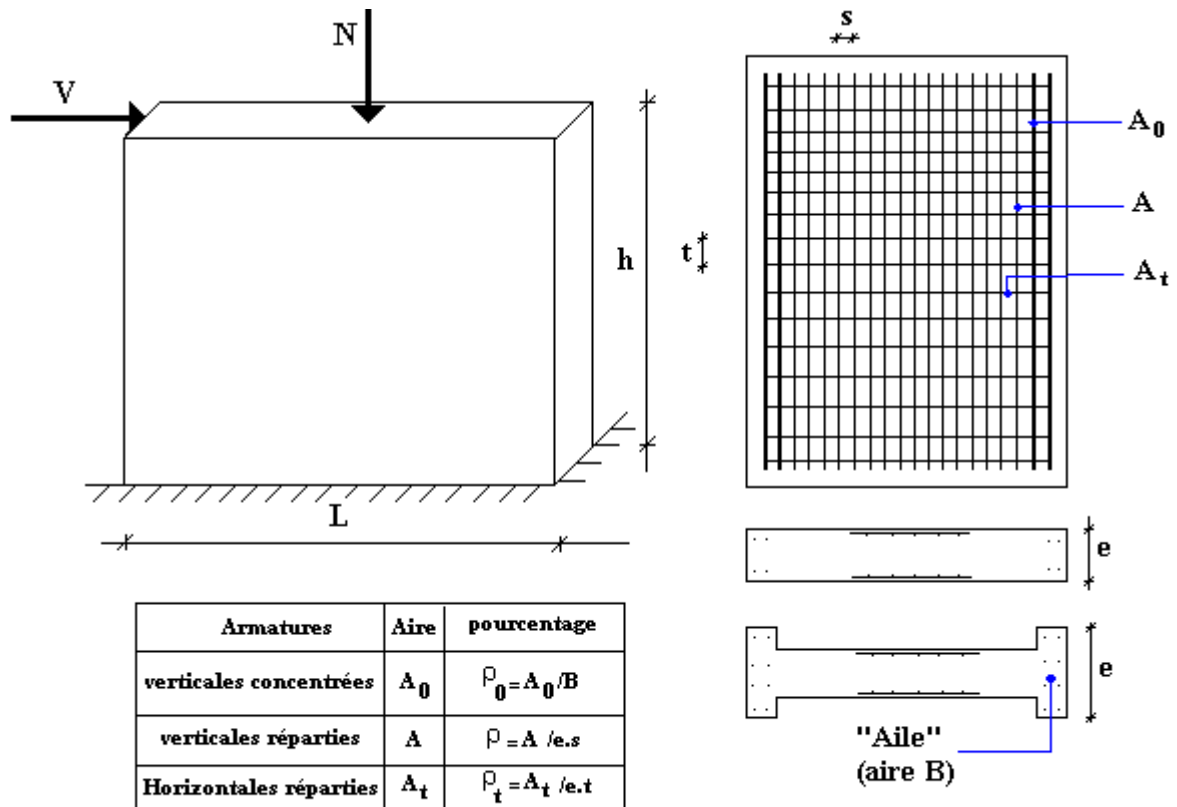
Schéma d'un voile plein et disposition du ferrailage
